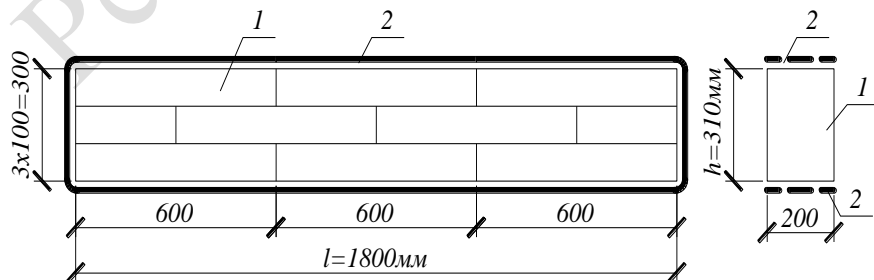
Конструкция перемычки из газобетонных блоков с перевязкой швов
